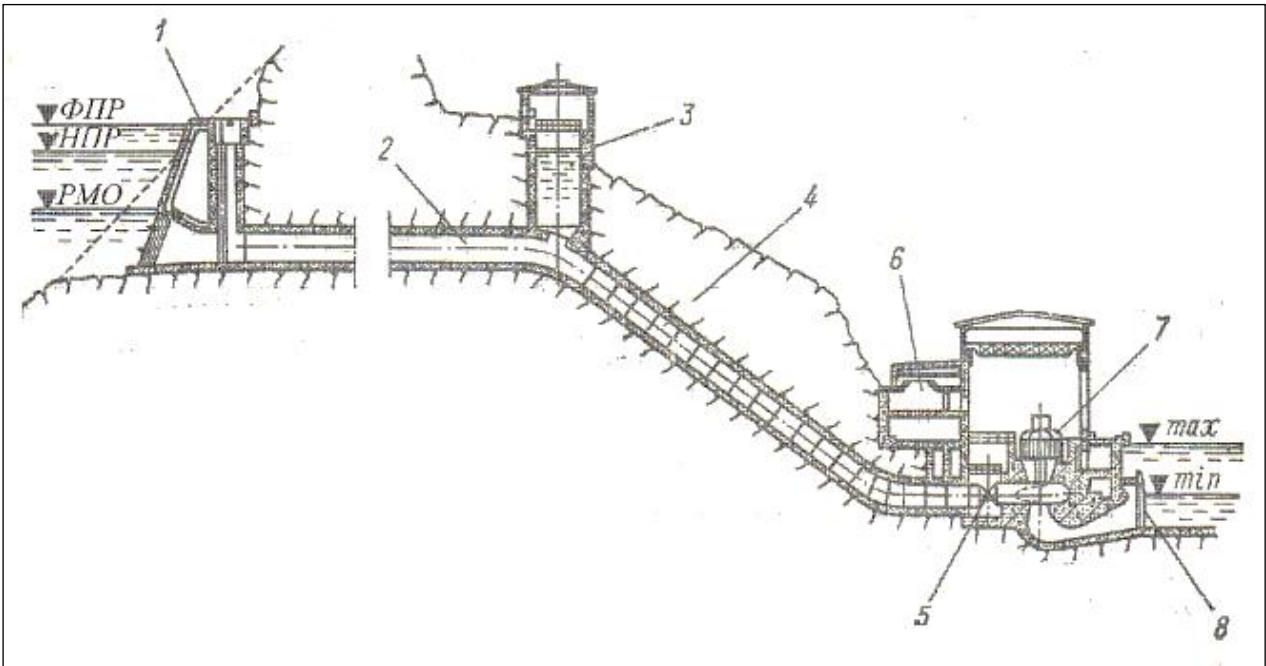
Середньонапірна дериваційна ГЕС з РО турбінами і підводом води напірними штольнями: 1 – водоприймач тунельного типу із шахтою; 2 – напірний тунель; 3 – зрівнювальний резервуар; 4 – напірні штольні; 5 – турбінний затвор; 6 – приміщення електричних пристроїв; 7 – гідрогенератор із збуджувачем; 8 – ремонтна загорожа відсмоктувальних труб
